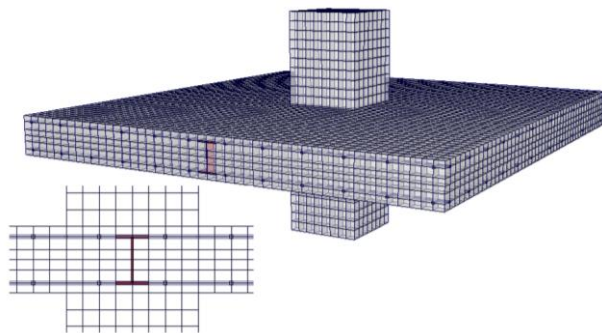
Фрагмент уточненной модели узла сопряжения колонны и плиты перекрытия с жёсткой арматуры в виде одного двутавра №14
